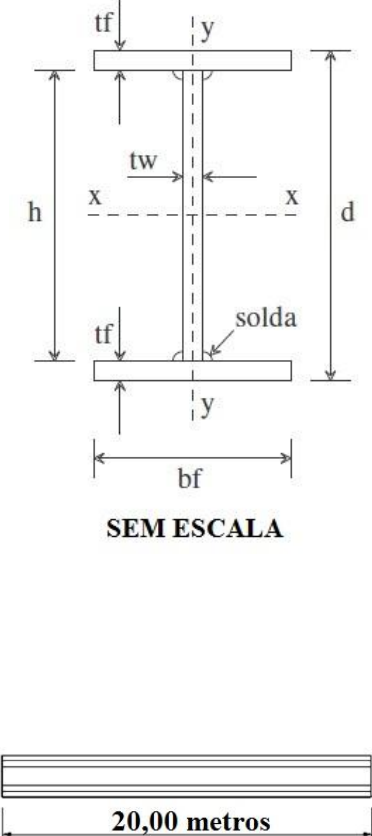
Detalhamento Longitudinal da Ponte Ferroviária do km 126+900
